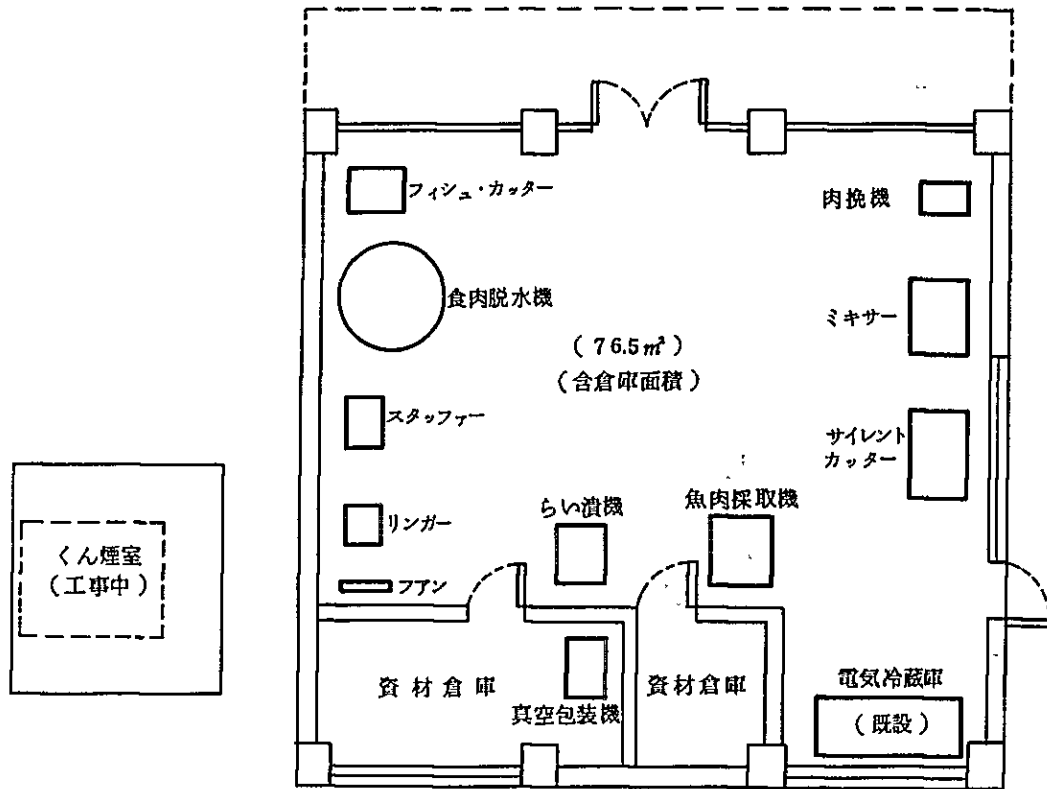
1) 食品製造実習工場平面図 (その 1)
